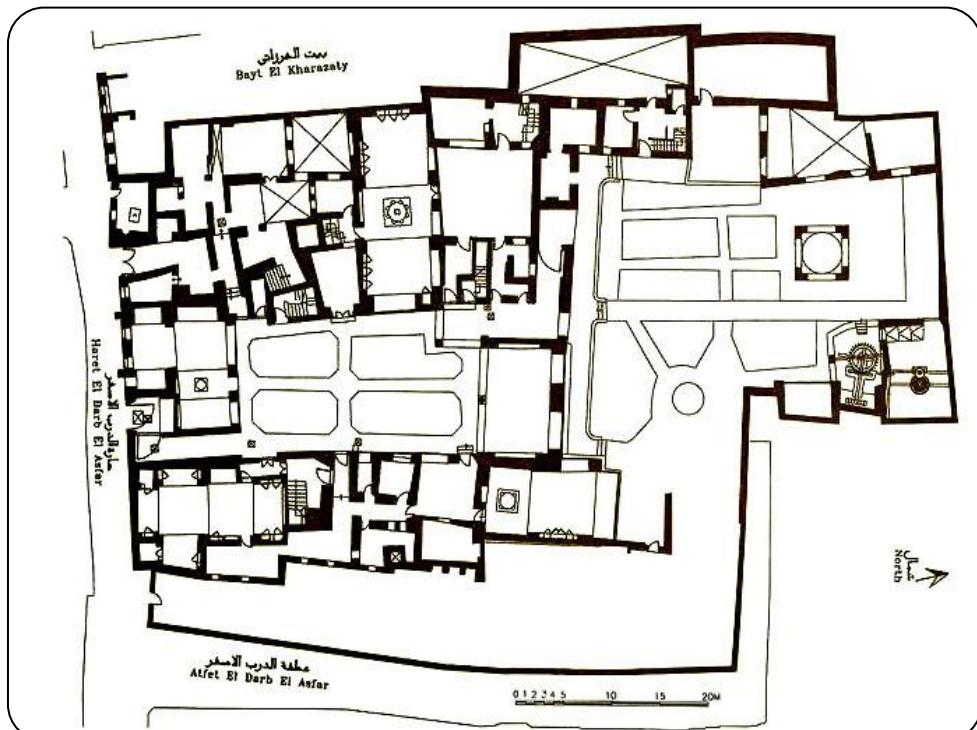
المسقط الأفقي للدور الأرضي لمترالست وسيلة
